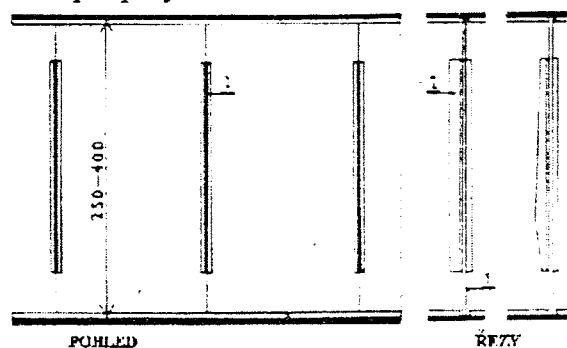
Vodorovný řez skleněnou výztuhou třetí konstrukční úpravy
